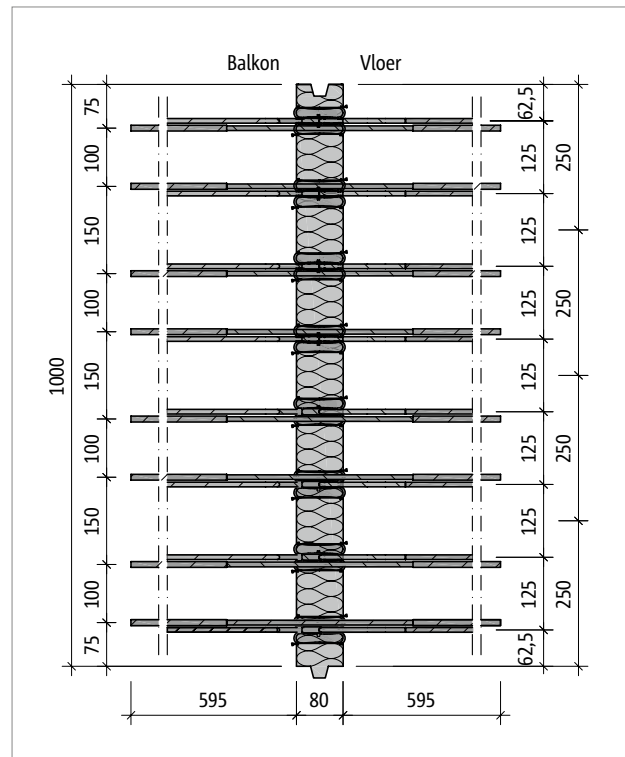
Schöck Isokorf® T type K-T-M1, K-E-M2, K-T-M3: Zijaanzicht
